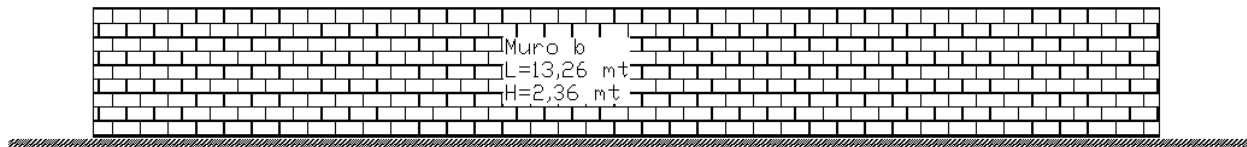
38. Muro Central Eje Y, edificio 5 pisos
